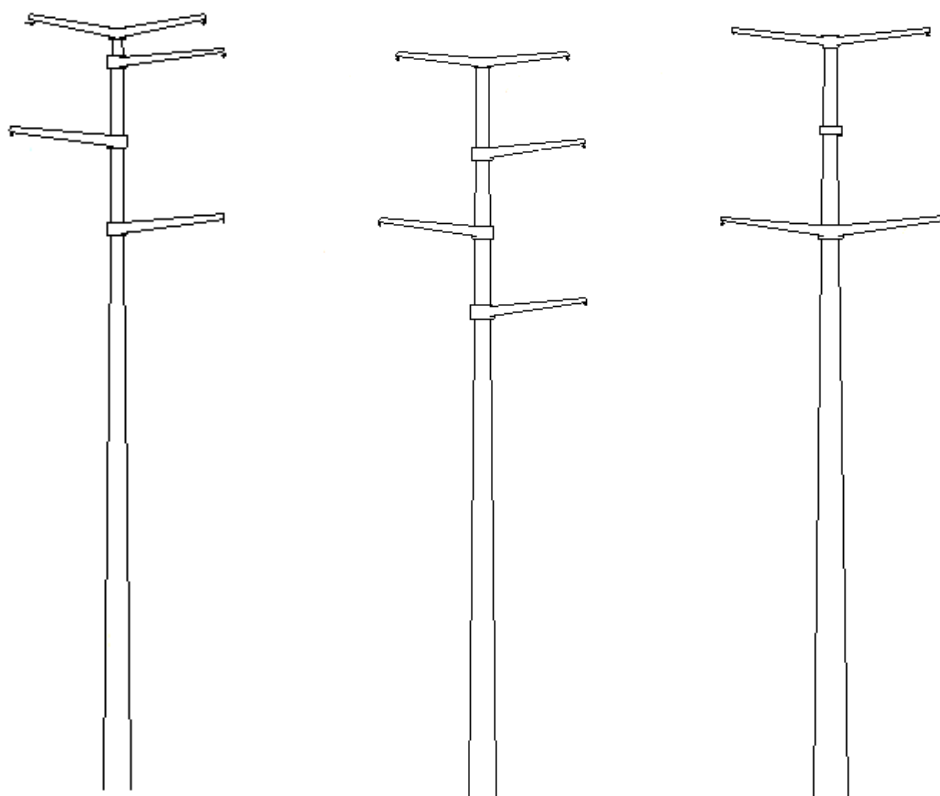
Estruturas de Concreto SSC, ASC e ASCE.
